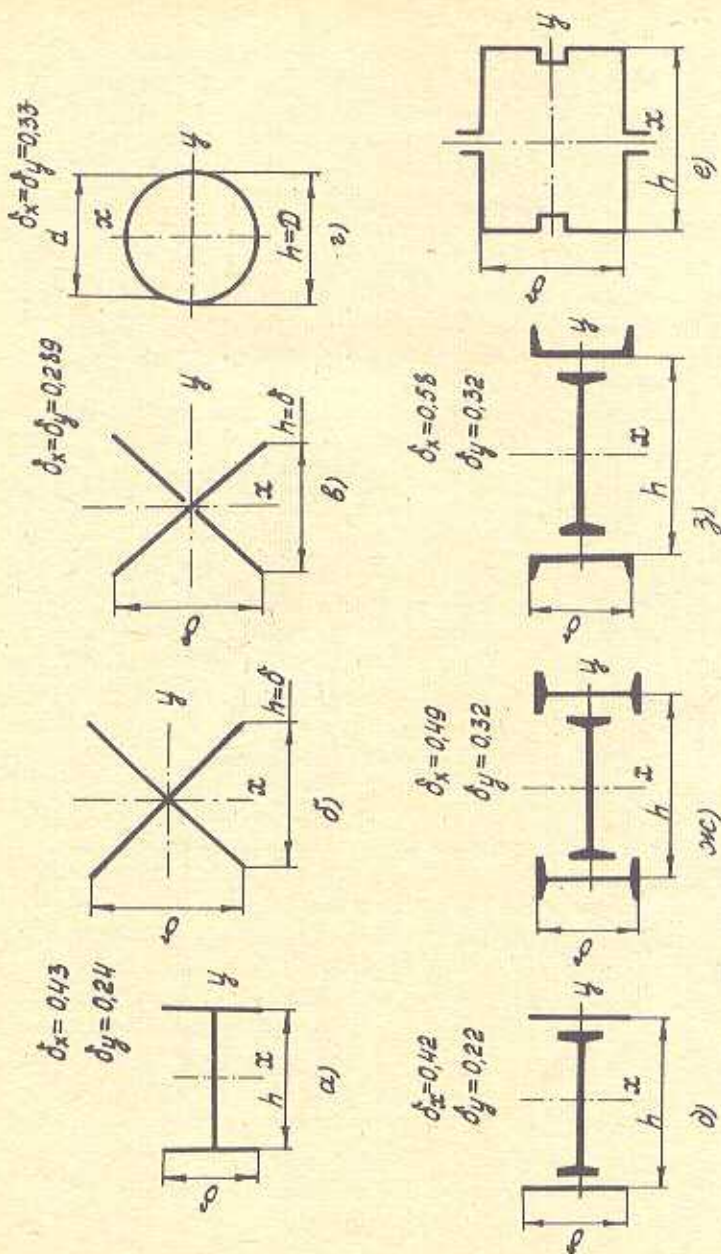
Типы сечений стержней сплошных сварных колонн
